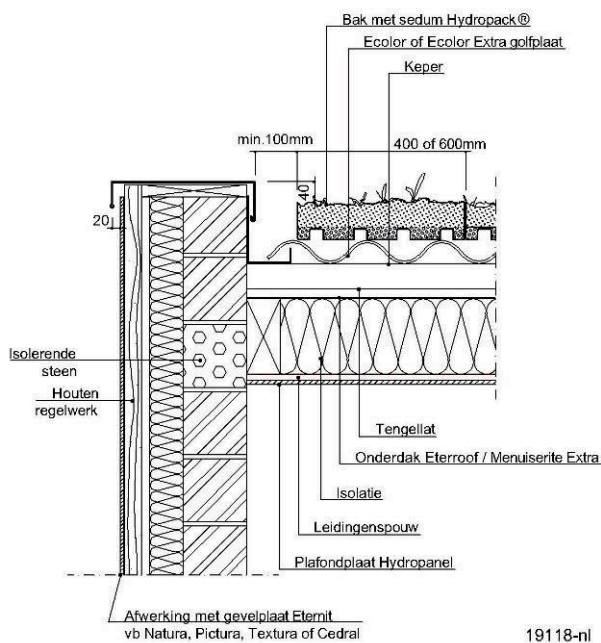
Zijrandafwerking met volledige Hydropack® Constructie met gevelplaat
